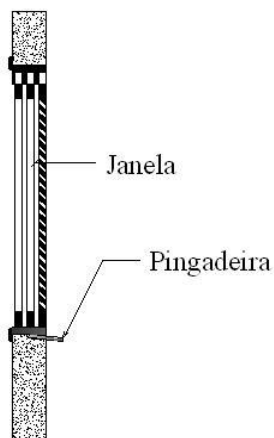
Demonstração da pingadeira executada em vãos de janelas (fonte: site Esquadrias Primos).
